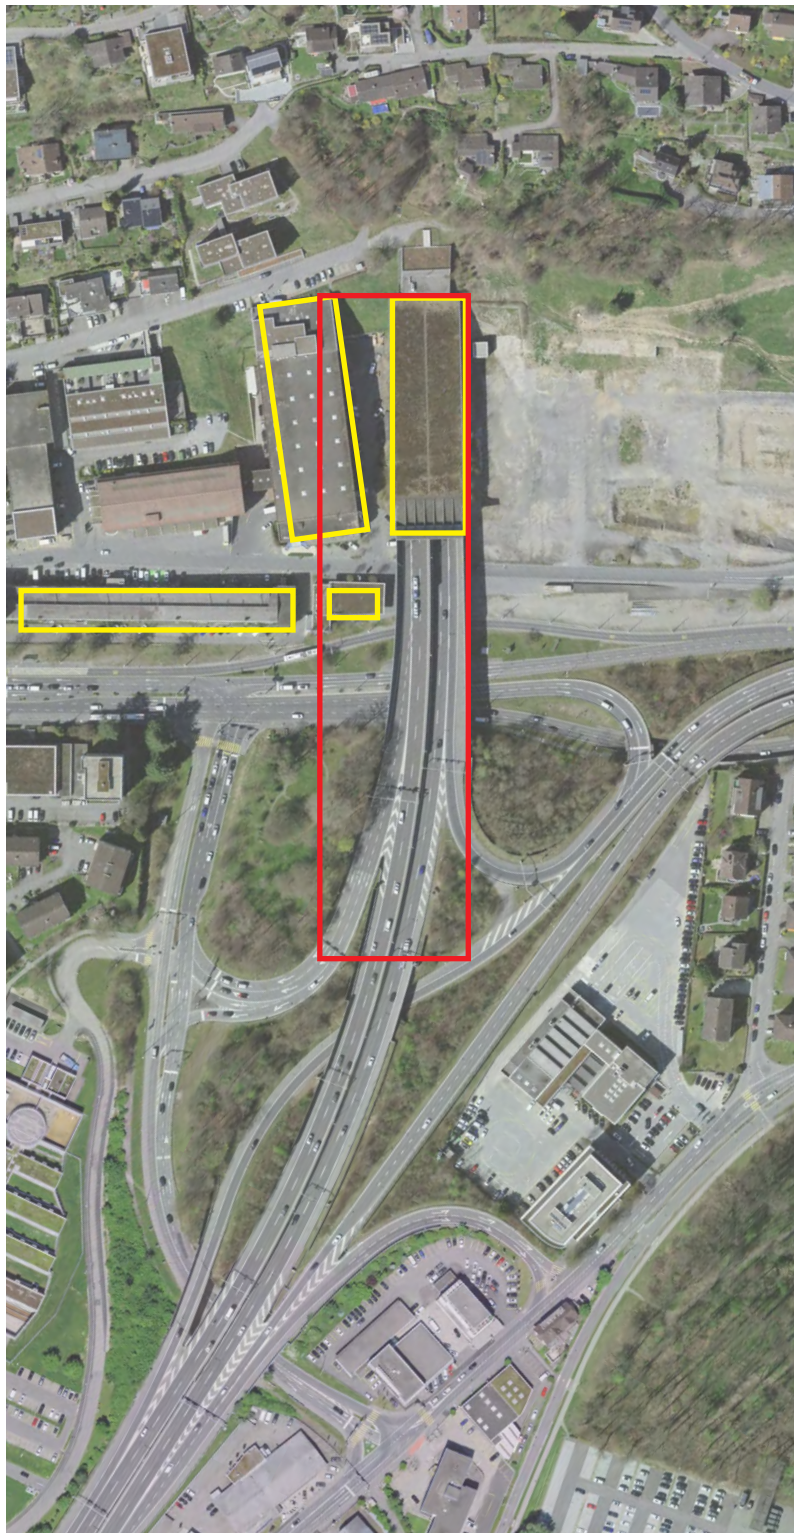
Luftbild. Gelb; Abbruch, rot; Neubau. Die bestehende Grosshofbrücke, die Tankstelle, sowie das Industriegebäude der Firma Herzog Elmiger müssten dem Neubau weichen. Der längliche Industriebau entlang der Langsägstrasse würde ebenfalls abgerissen, um als Baustelleninstallationsplatz dienen zu können, 2024.
